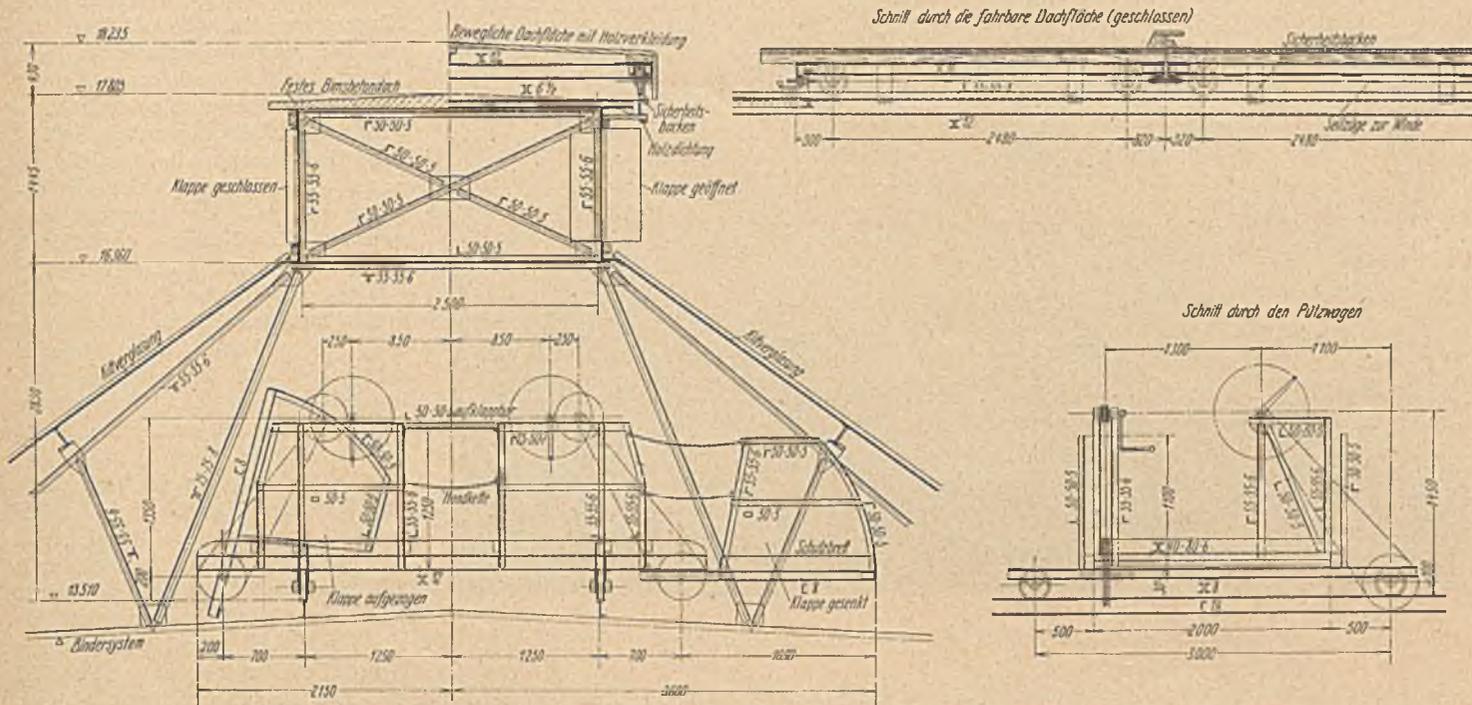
Dachaufbau mit Putzwagen und fahrbarer Dachfläche.
